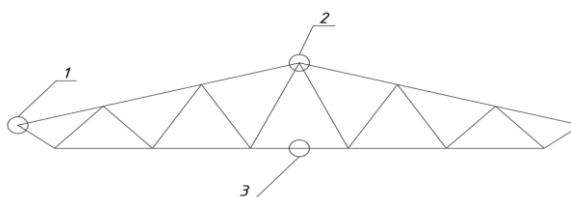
Схема размещения рассчитываемых узлов фермы
